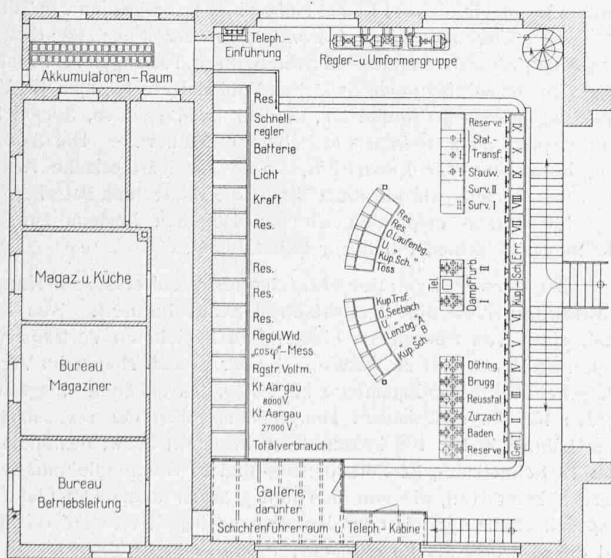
Grundriss der Kommandostelle. — 1:250.
